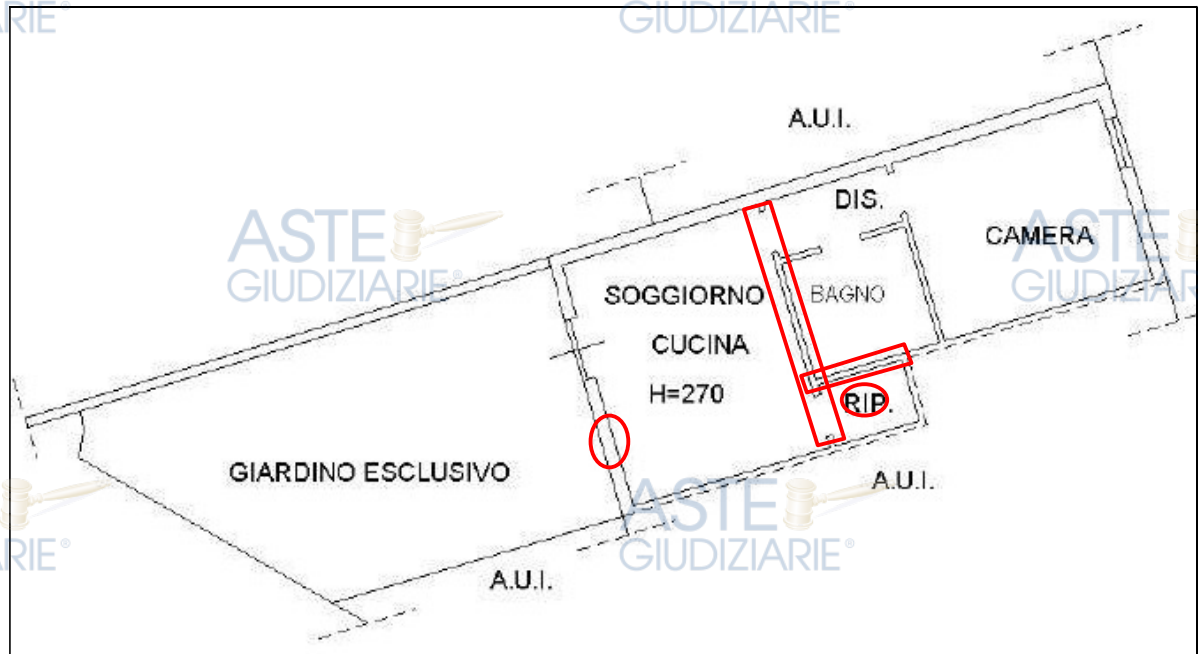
Estratto planimetria catastale sub. 1 con indicazione delle difformità rilevate
